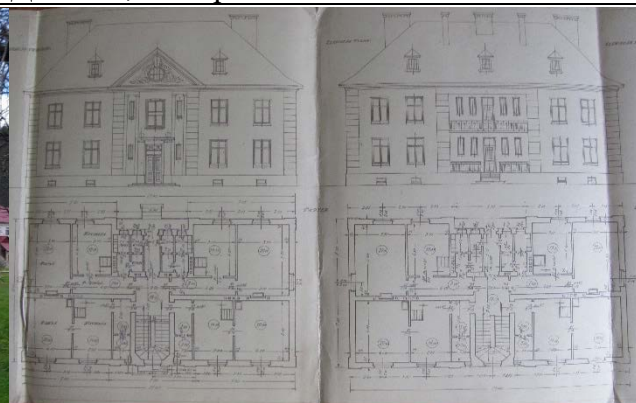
Фрагмент креслень фасадів і планів будинку для житла службовців біля станції Вороненка [19].
